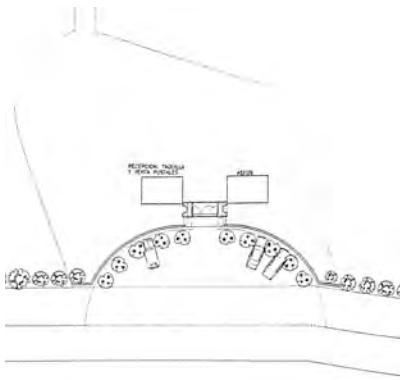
Planimetría del proyecto de acceso al yacimiento. (Page, 1998)
